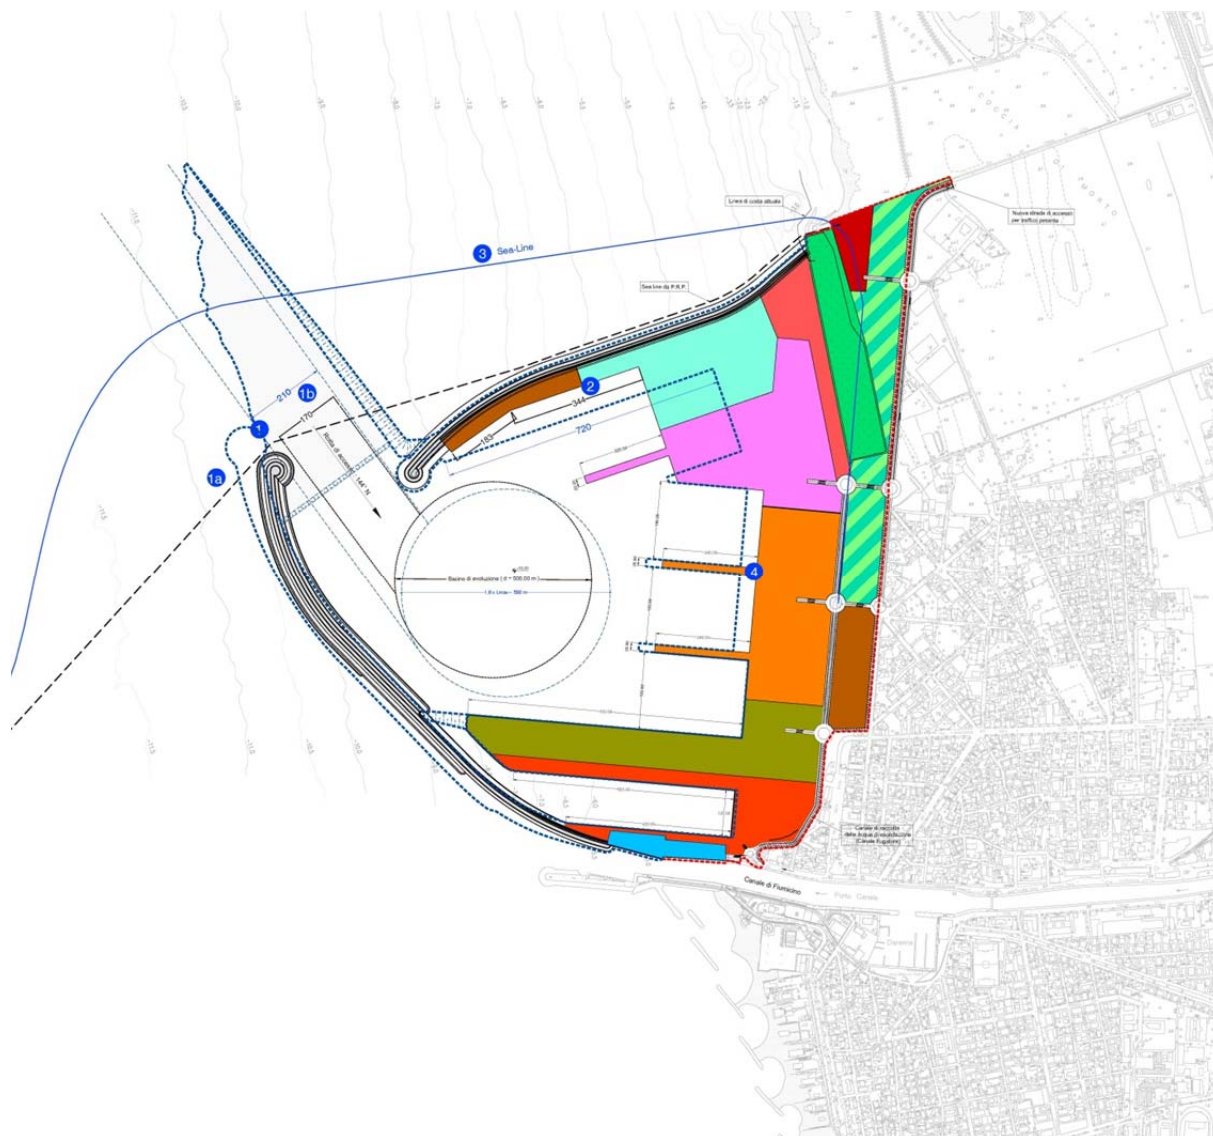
Planimetria con evidenziazione della proposta di A.T.F. confrontata con il P.R.P. vigente
